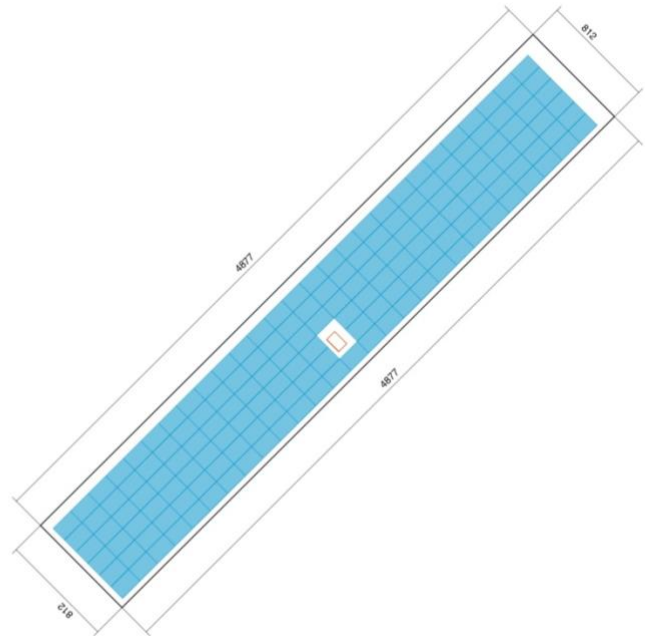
Rapperswilerstrasse 20, Belegungsplan, Dachfläche 2: Nord-West
